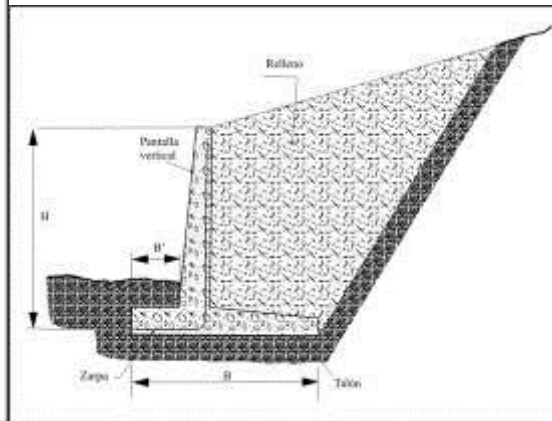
Muros de concreto armado tipo flexión (tomado de INGEMMET, 2000).
